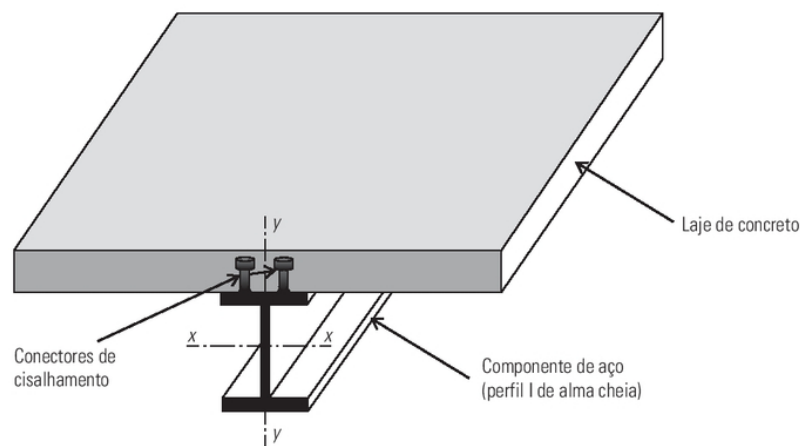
Detalhe do sistema estrutural com viga mista (FAKURY, 2016)
